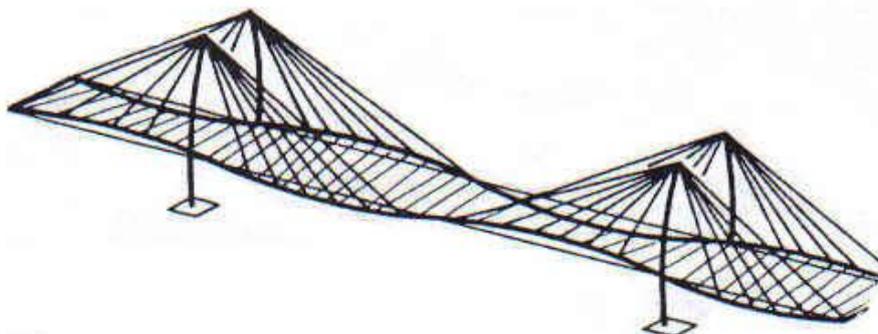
Puentes Atirantados con suspensión lateral vertical
